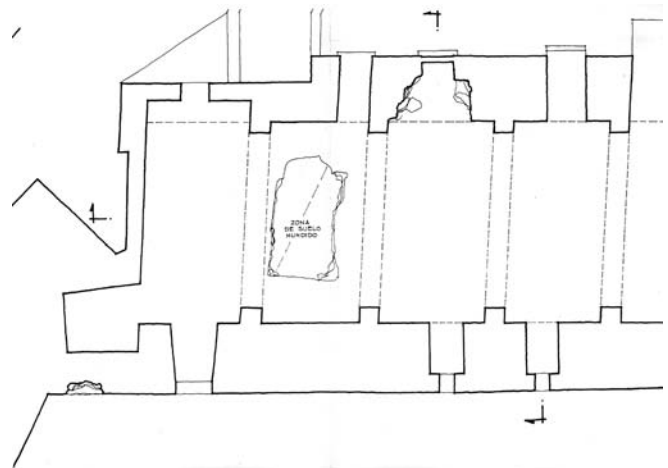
1979. Oscurico. Estado Actual. Planta Baja. Pons
